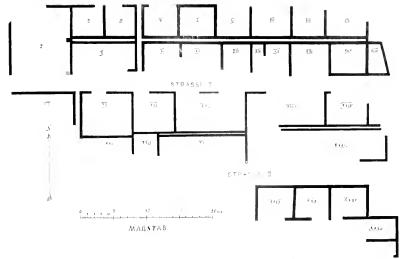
Straßen mit Grundrissen der flankierenden Gebäude
